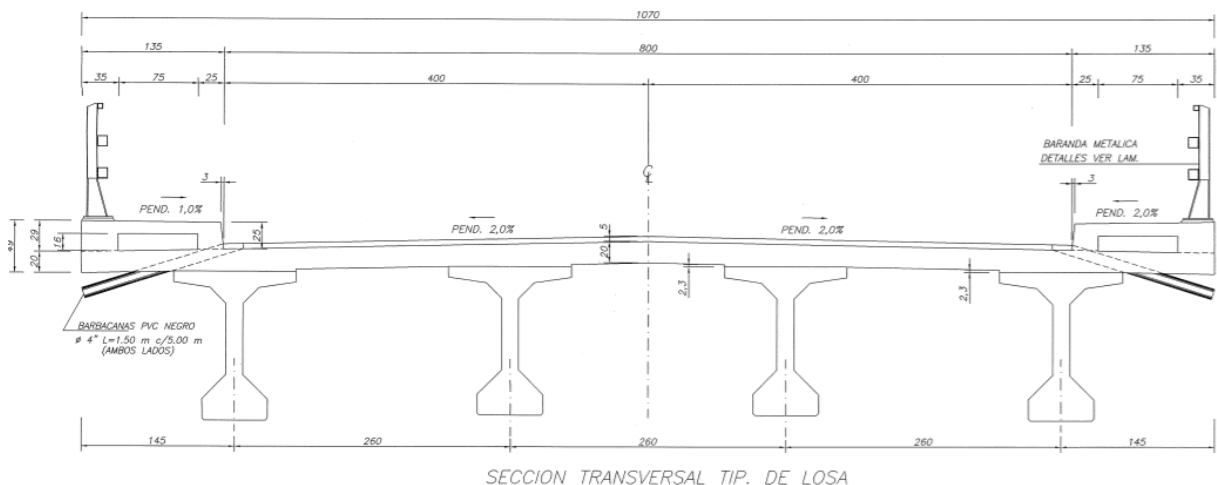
Sección transversal de puente Águila Norte. Planos Puente MOP [41].
